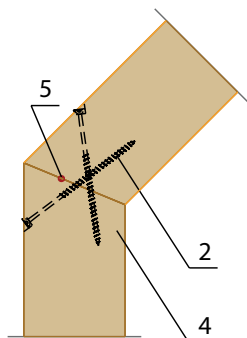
DETAIL PODÉLNÉHO SPOJE 62 – s přeplátováním
